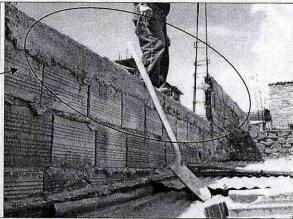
Detalle de cubierta, ya en proceso de reparación, y lugar donde se encontraba el muro. Diferencia de altura de 80 cms. aproximadamente entre la placa y la cubierta affectada
